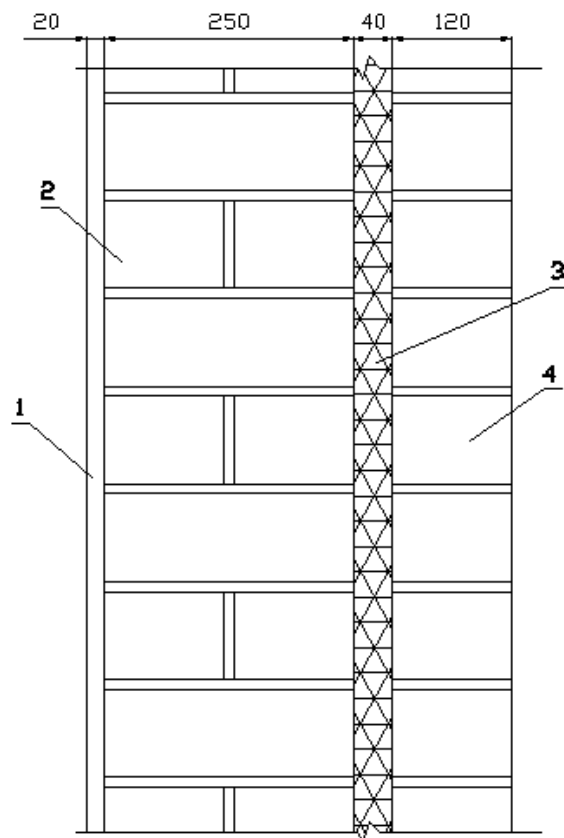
Конструкция наружной стены жилого дома в г.Самарканде
